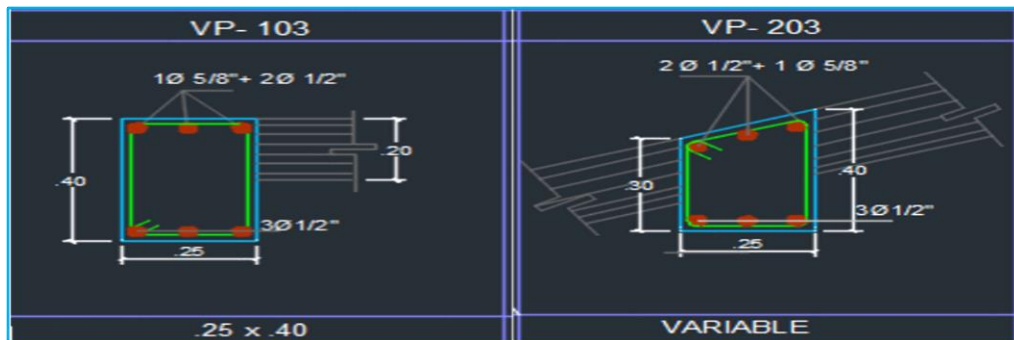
Detalle de las dimensiones de la viga VP-103 y VP-203 y su respectivo acero de refuerzo
